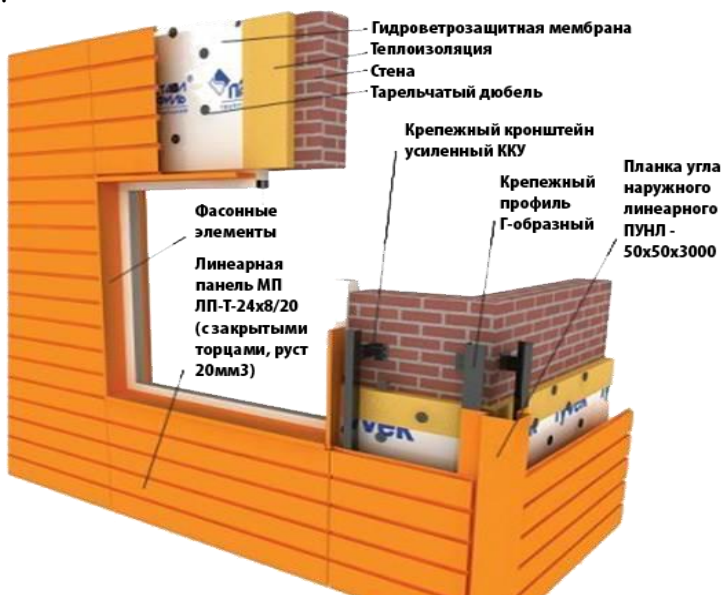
Схема устройства вентилируемого фасада из линейных панелей
